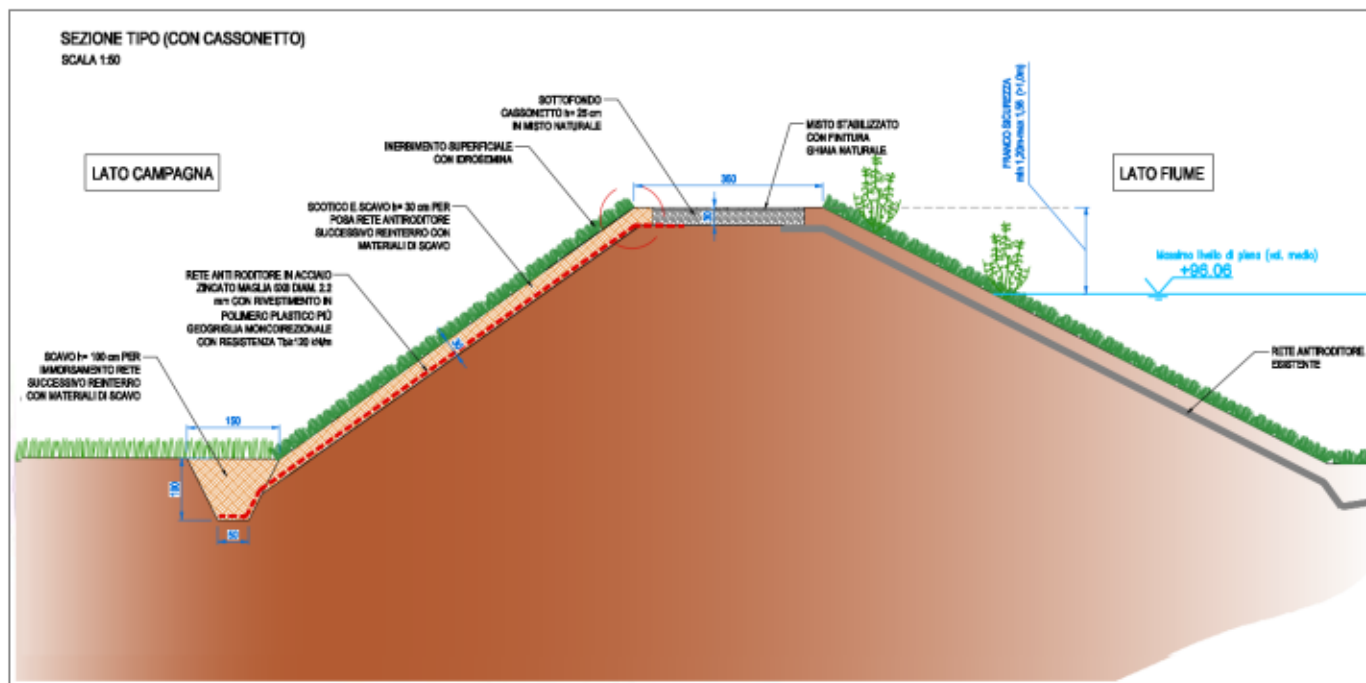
Stralcio progettuale Sezione tipo con cassonetto.
